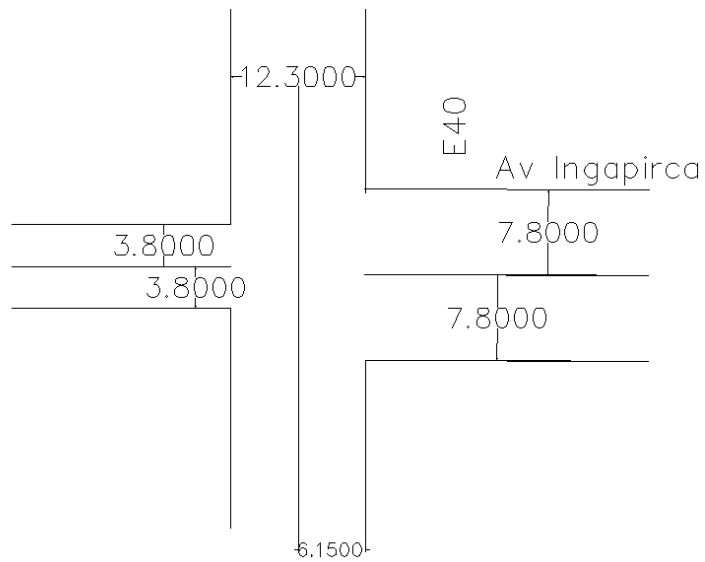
Geometría de la intersección 5. Fuente: Elaboración Propia
